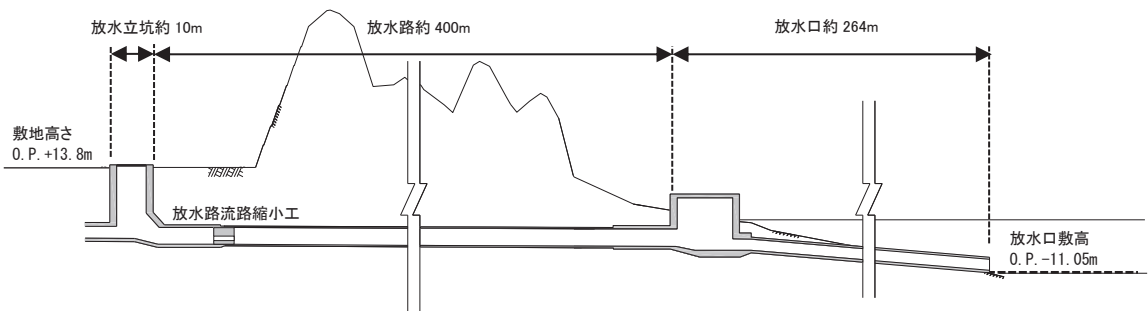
(4) 水路縦断面図 (第 1 号機放水路 A'-A' 断面図)
